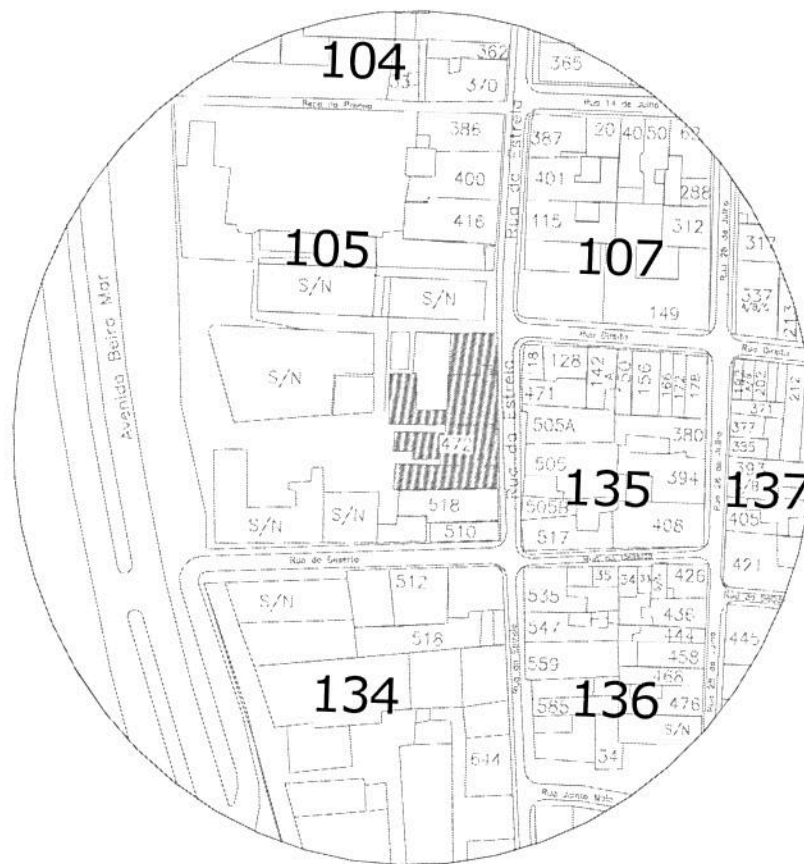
Planta de Localização dos Prédios do CAU-UEMA - Sem Escala
